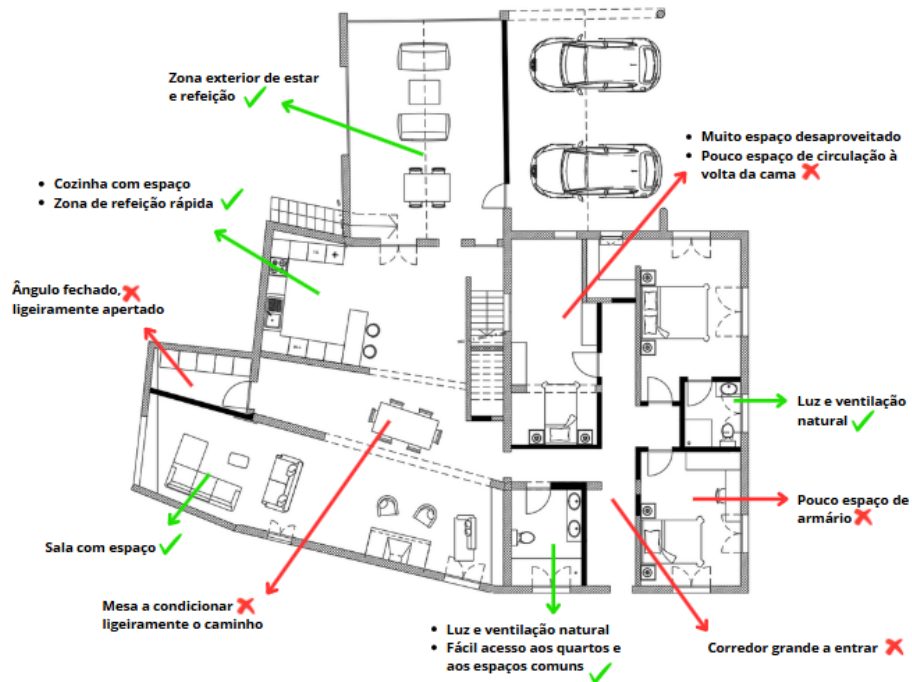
Análise de plantas esboço, proposta 3, piso 0
